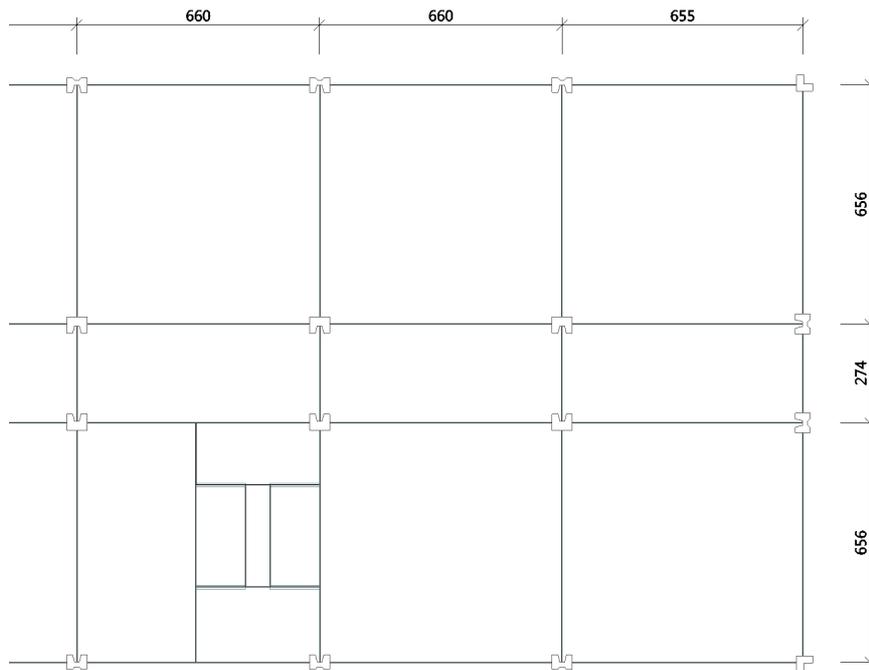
Grundriss Nordtrakt - Ausrichtung der Stützen
